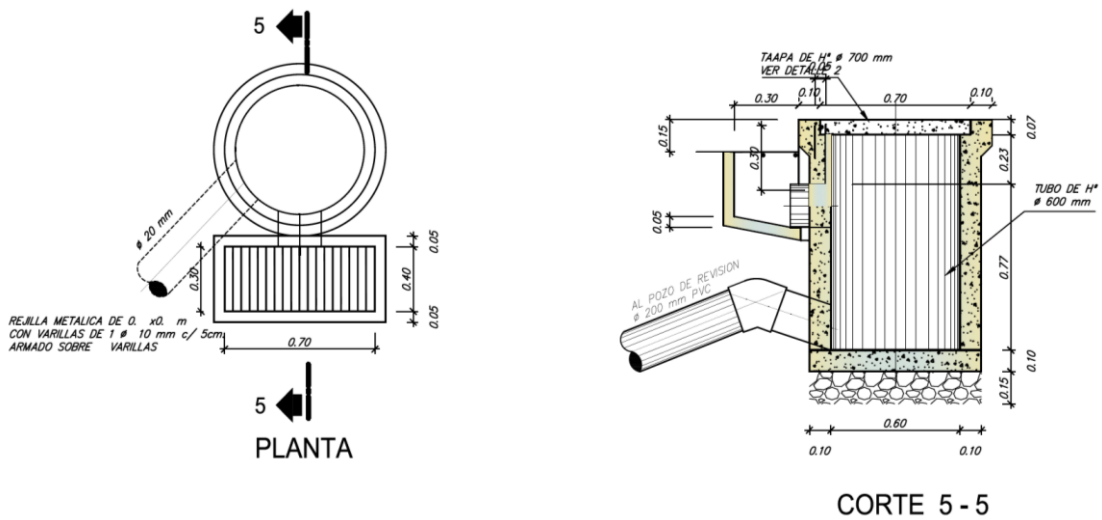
Sumidero vista en planta. Elaboración: ETAPA EP
